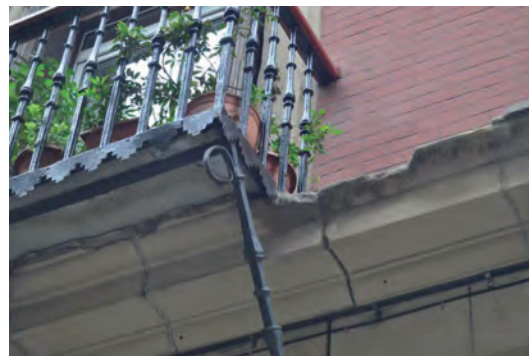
47. DEGRADACIÓN CON PÉRDIDA DE MATERIAL DE LA CORNISA DE PIEDRA EN FACHADA PRINCIPAL¹⁰
